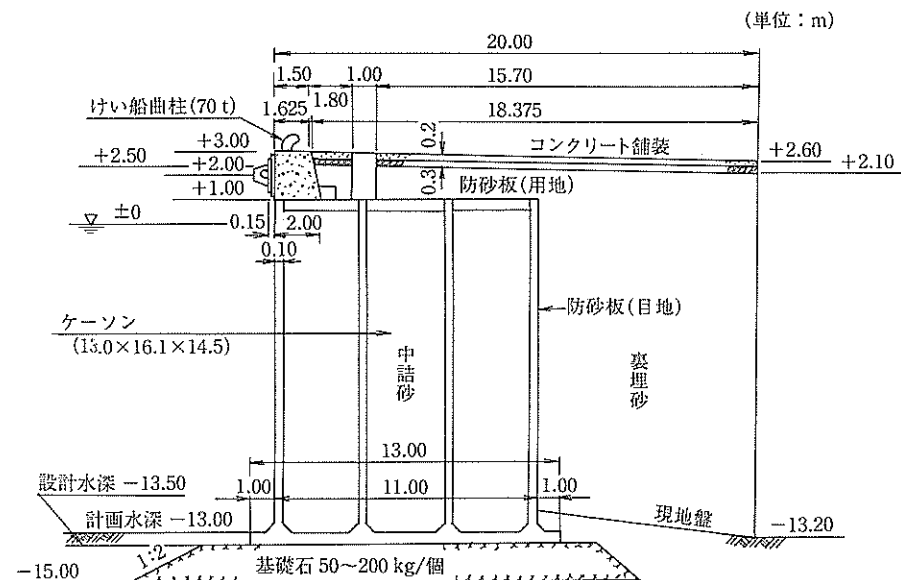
(1) 外港-13m岸壁標準断面図⁷⁾
